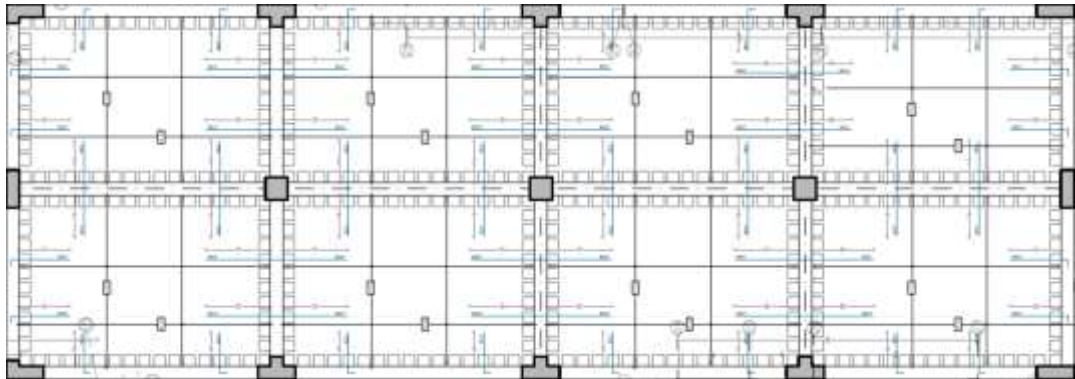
Pre dimensionamiento losa aligerada bloque sector.
